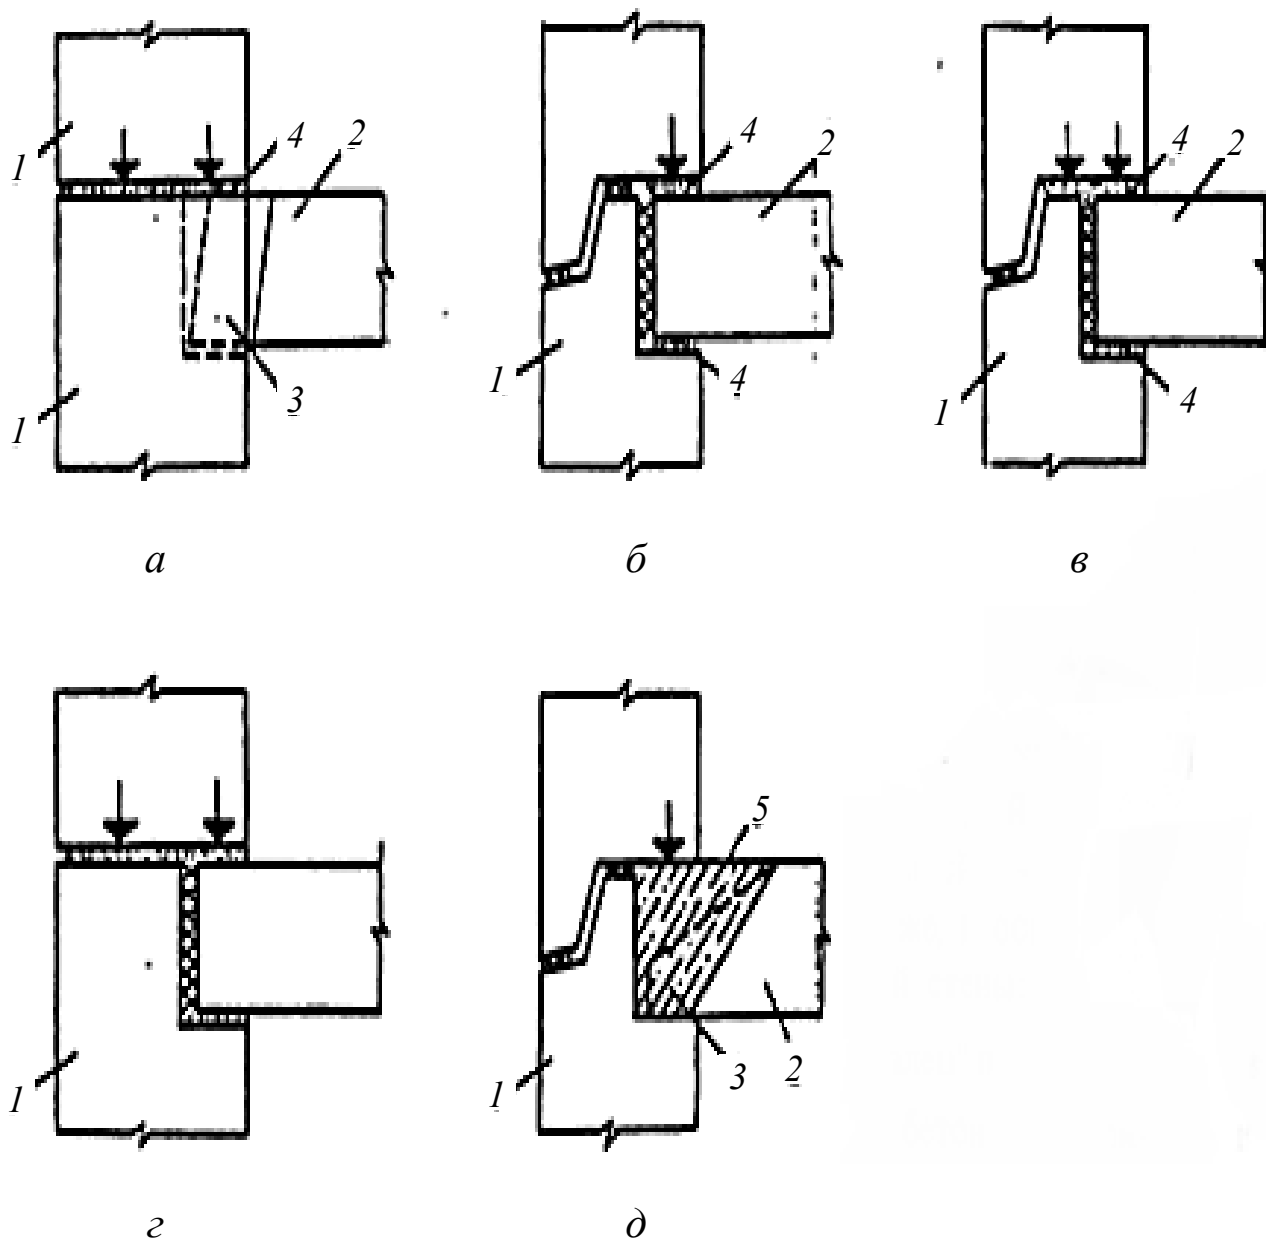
Горизонтальные стыки наружных панельных стен и схемы передачи в них вертикальной нагрузки:
